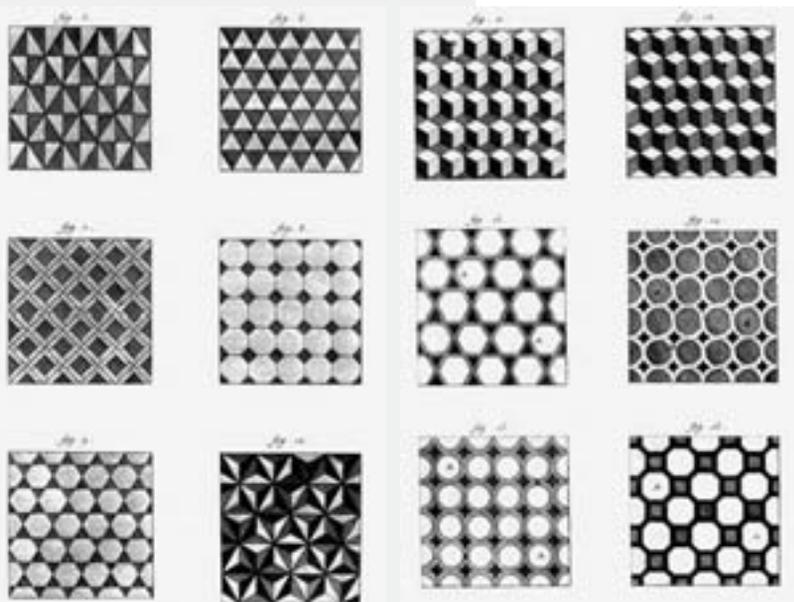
Pavimenti con geometrie di posa a misura fissa, da uno a più formati di differente colore.
